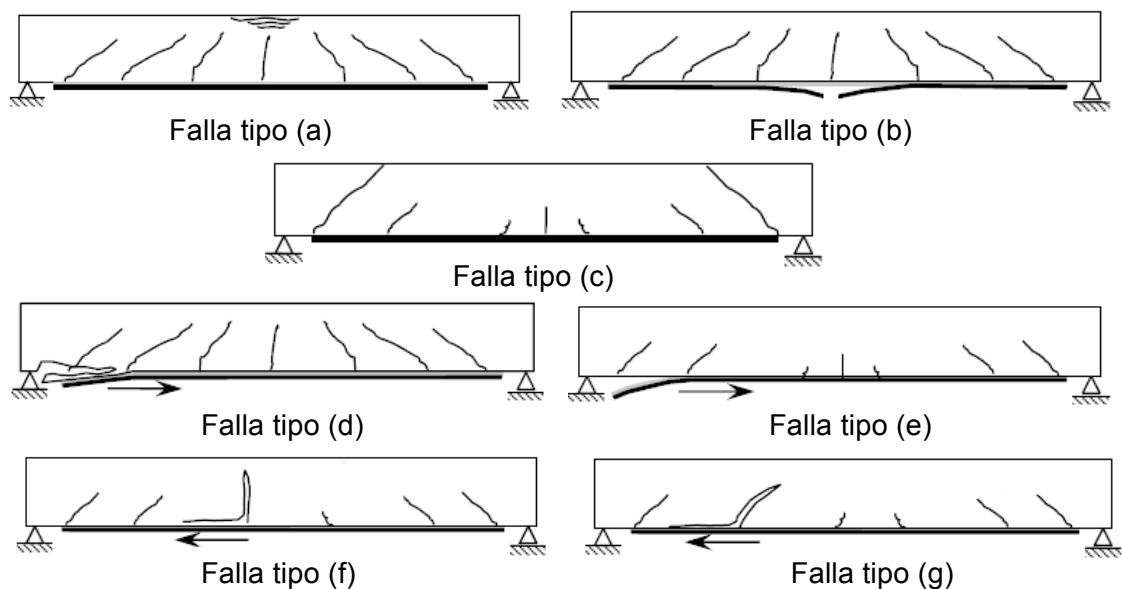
Tipos de falla de vigas de hormigón armado reforzadas con PRFs [5]
